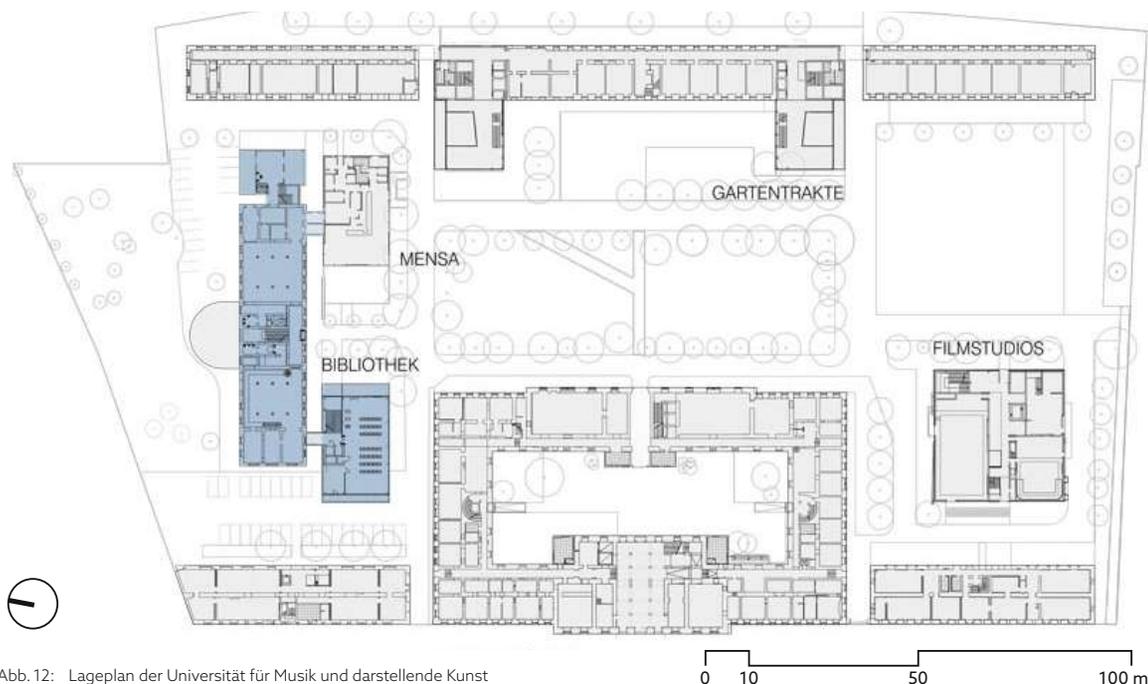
Lageplan der Universität für Musik und darstellende Kunst
